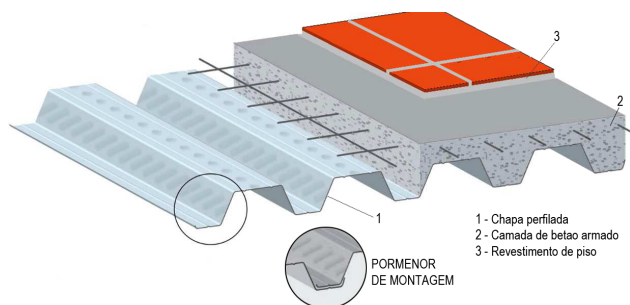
Perspetiva de um pavimento de laje mista de aço-betão COLABORANTE PC65
